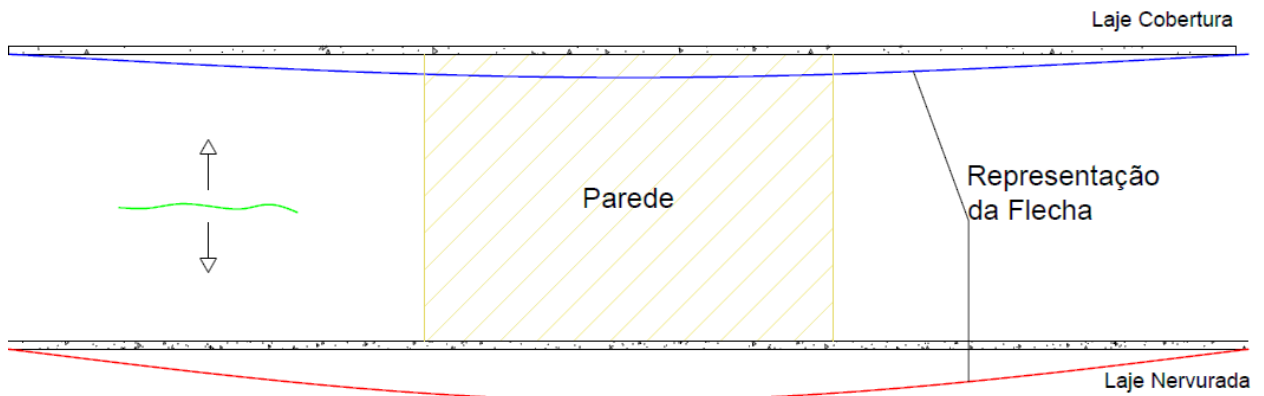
Corte longitudinal do corredor – Flechas das lajes (Sem escala)
